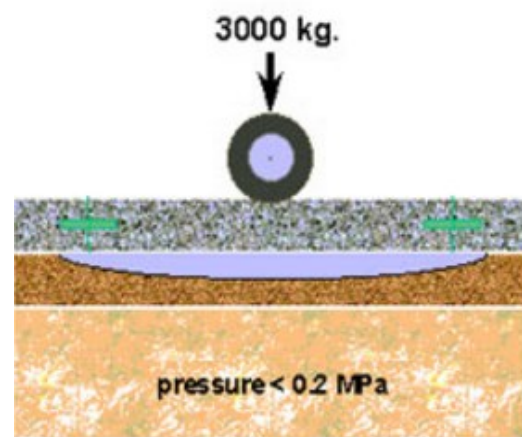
1. Distribuzione delle tensioni in una pavimentazione rigida.
